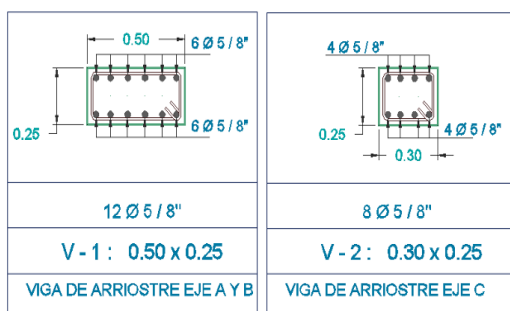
Vigas secundarias, Pabellón 1A.
